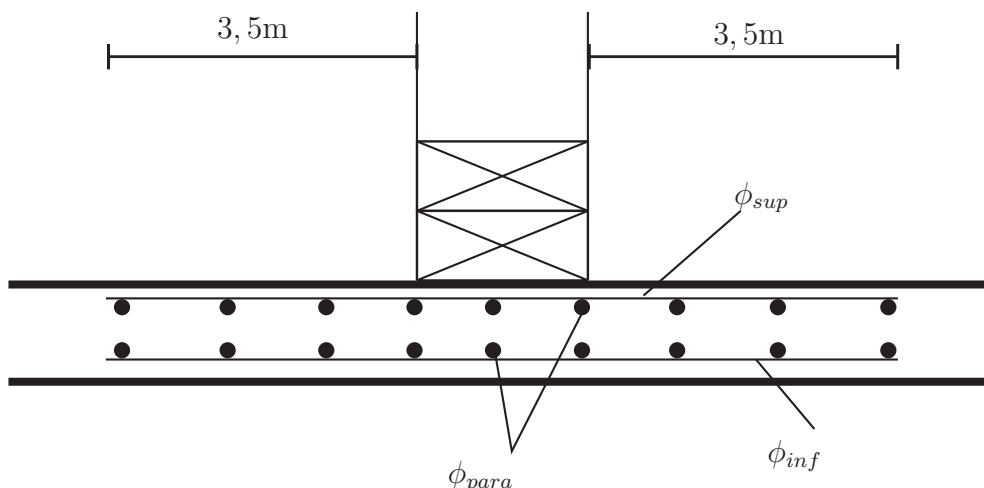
Esquema de armado de la platea en los muros “interiores”.
